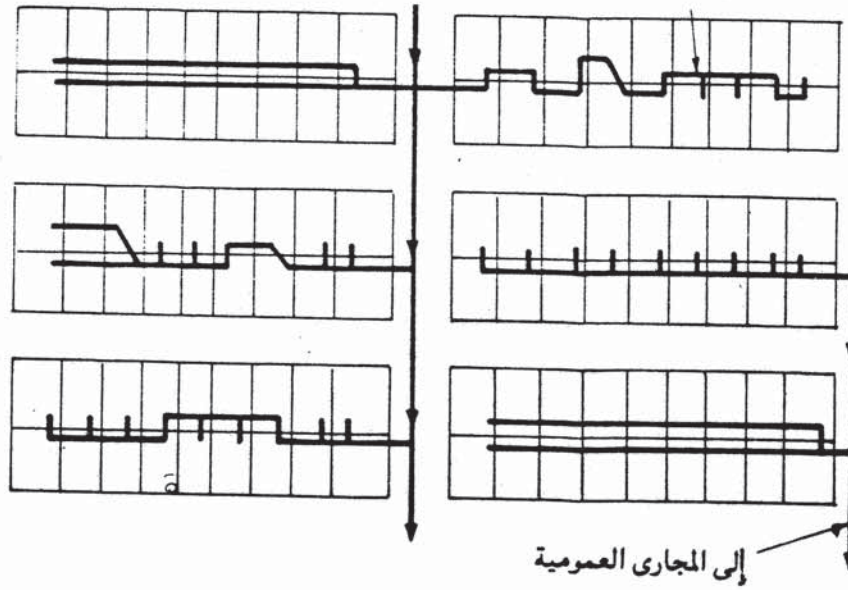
المكونات الأساسية لنظام الصرف الضحل . مرجع (٣٦)
